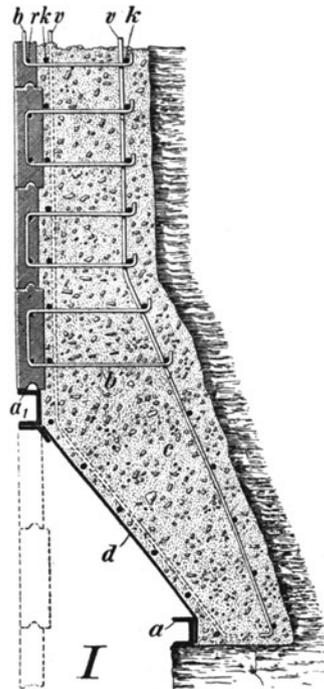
Schachtausbau mit Eisenbeton unter Verwendung von Formsteinen als Verschalung.
